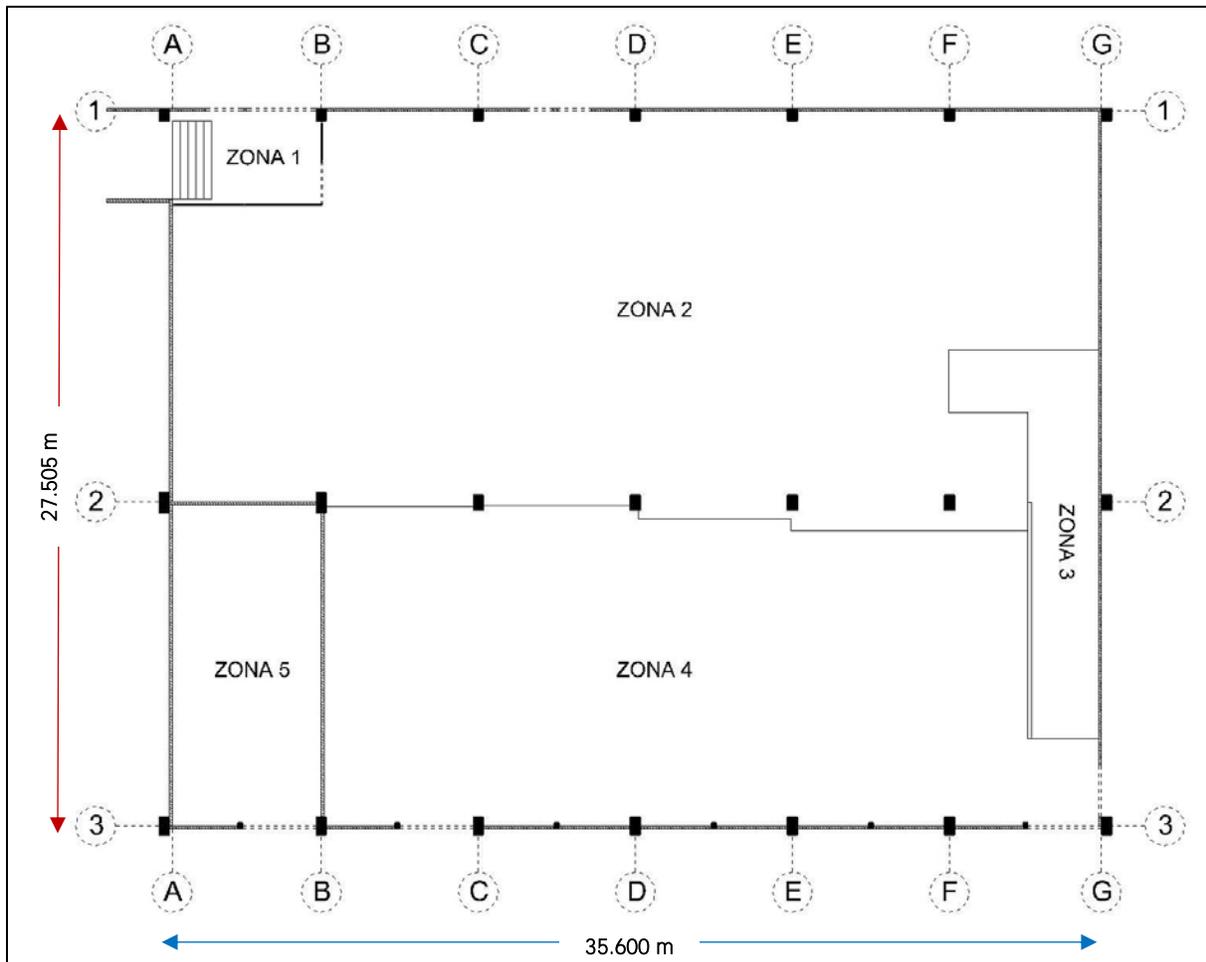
Plano de división de zonas en Planta Piloto.
